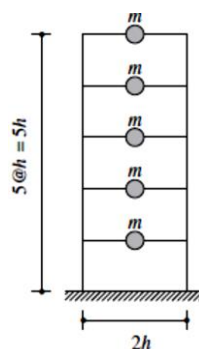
Pórtico com 5 pavimentos e propriedades constantes. (Chopra, 2012).
